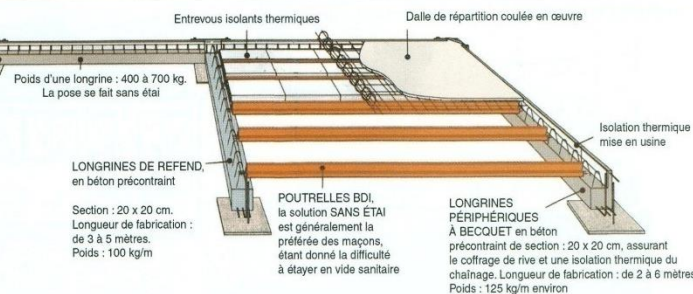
Vue d'ensemble du plancher sur vide sanitaire
